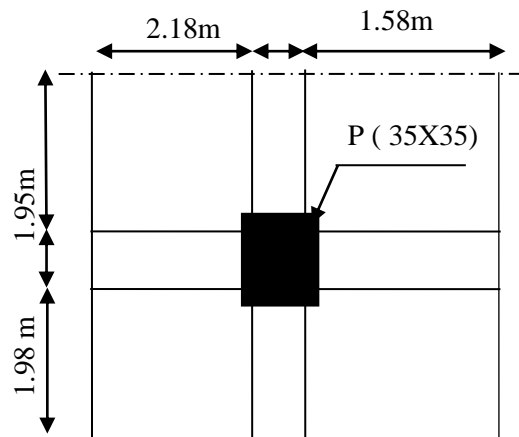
Surface revenant au poteau central du niveau RDC + étage 1 (poteau B2)
